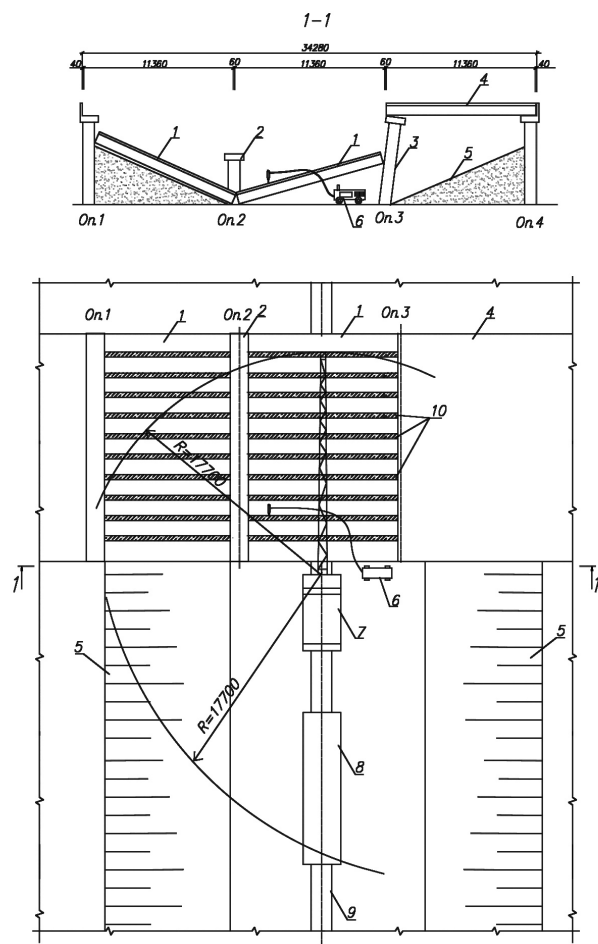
Разборка элементов мостового полотна: 1 – балки обрушенных пролетов; 2 – обрушенная опора № 2; 3 – опора № 3, имеющая крен; 4 – балки пролета 3-4; 5 – откосы; 6 – компрессор отбойного молотка; 7 – кран железнодорожный; 8 – грузовая ж/д платформа; 9 – ж/д пути; 10 – вырубаемые полосы асфальтобетона
